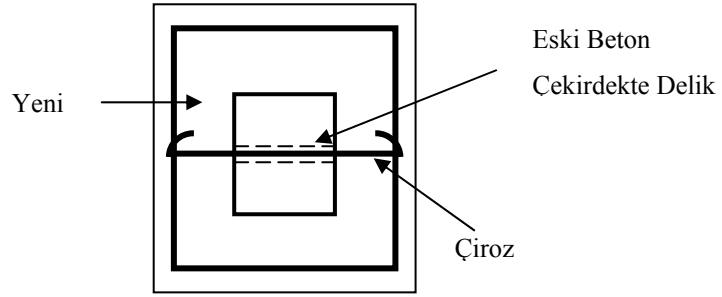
Kolonun Betonarme ile mantolanma uygulaması
